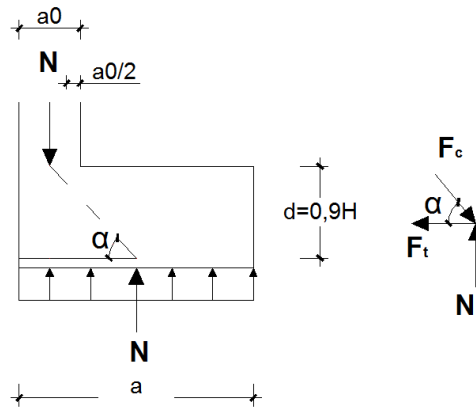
Esquema de cálculo das armaduras para as sapatas laterais
